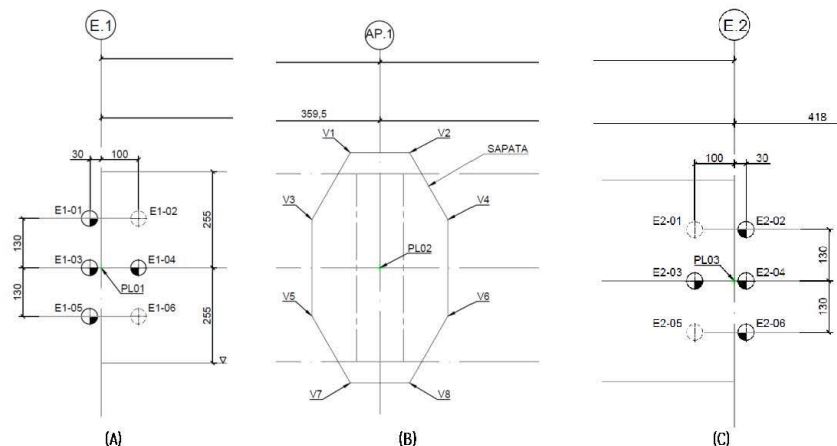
FUNDAÇÕES PROJETADAS PARA (A) ENCONTRO 01, (B) PILAR CENTRAL E (C) ENCONTRO 02
